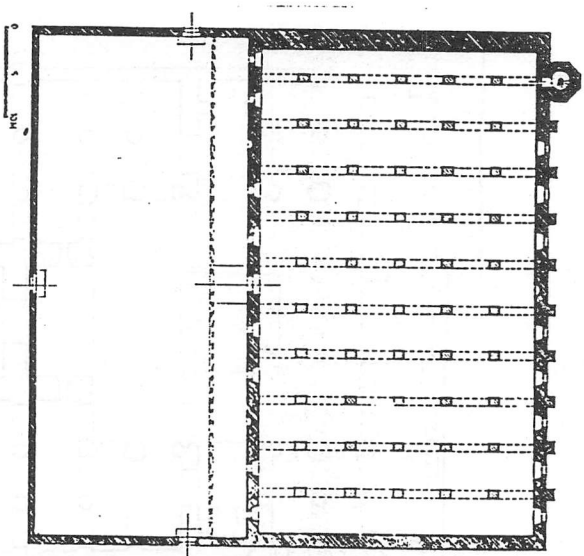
المسقط الأفقي لرباط سمسة في تونس .
